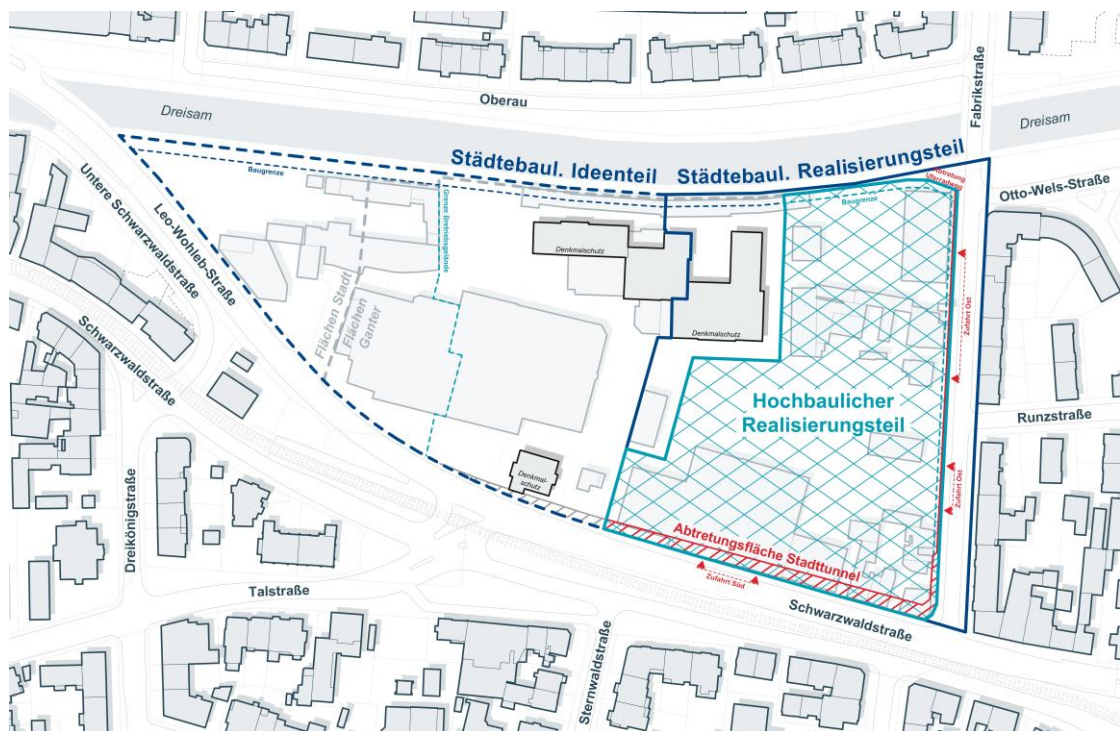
Lageplan im Modellausschnitt mit Rahmenbedingungen (Zufahrten / Abtretungsflächen)
